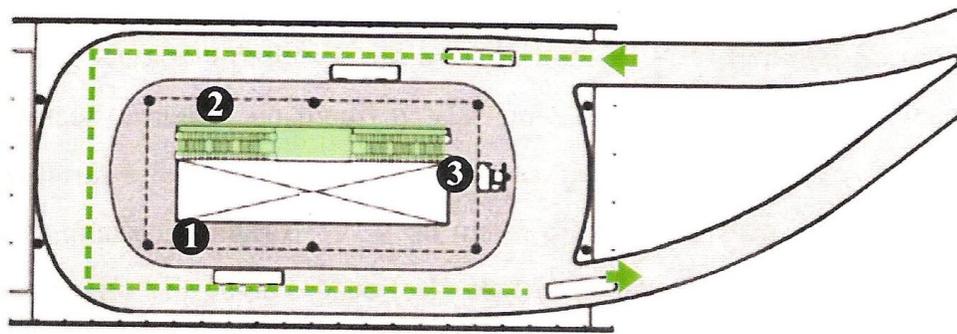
Planta do primeiro pavimento do Terminal Sacomã
